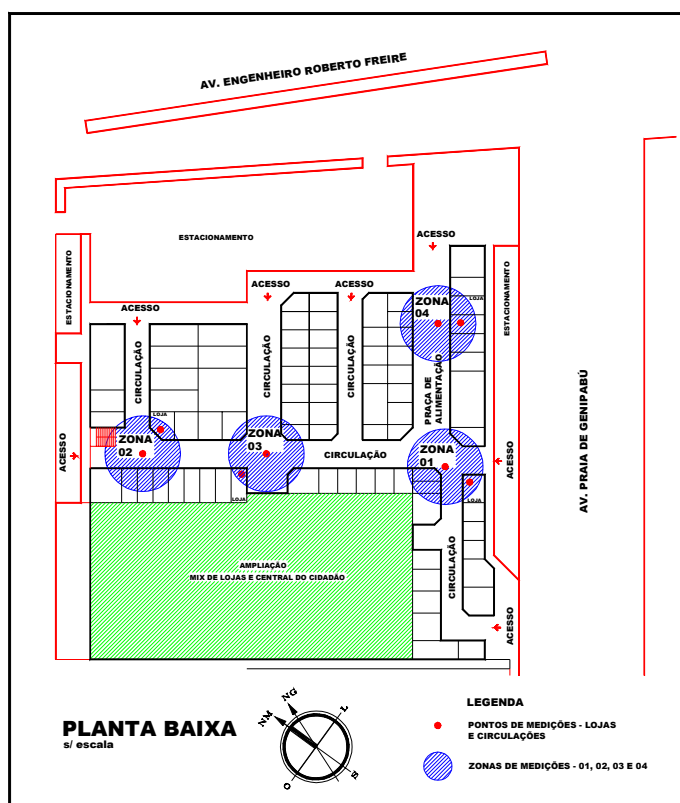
Planta baixa do Praia Shopping, com definição das zonas e pontos de medições.
